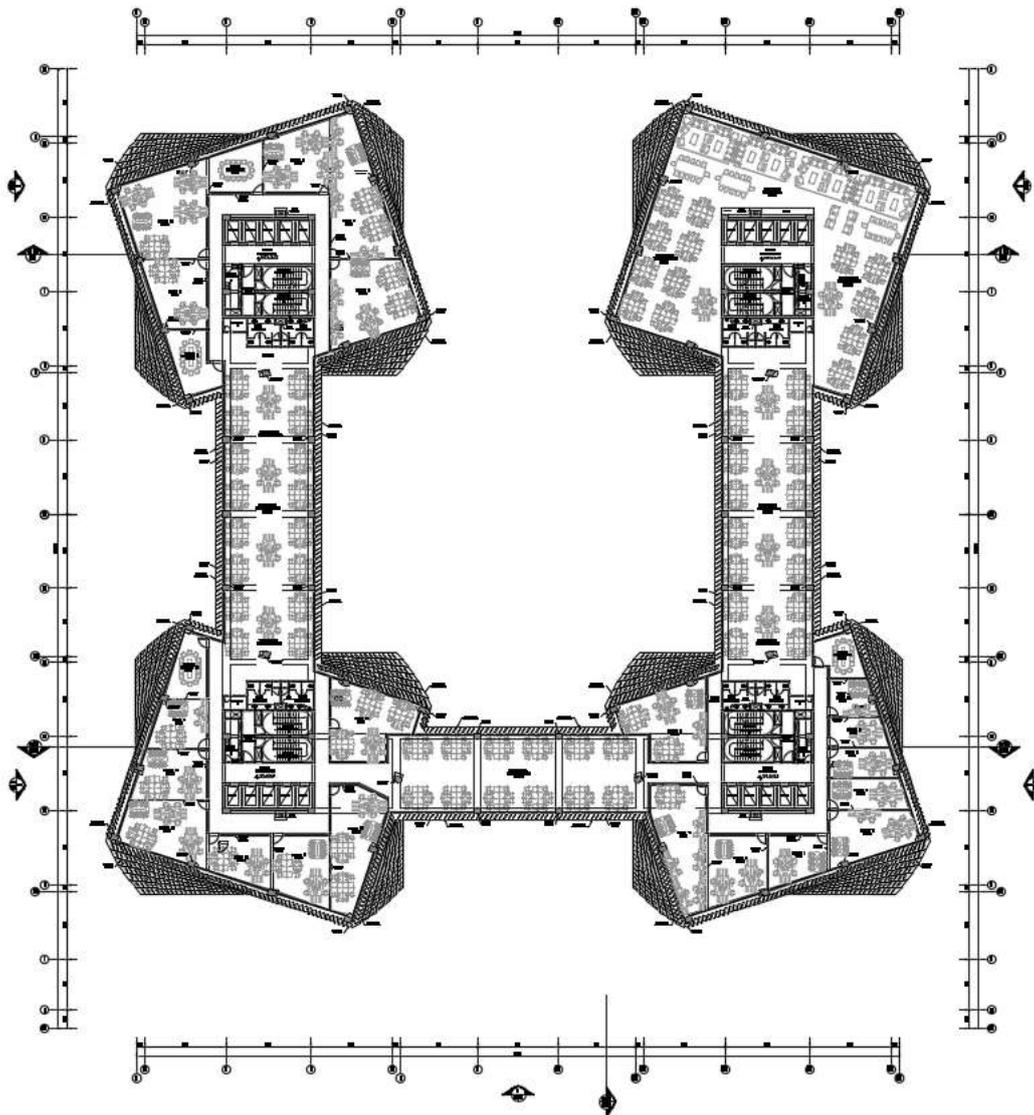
Planta Típica Piso 10-11 - Elaboración Propia
